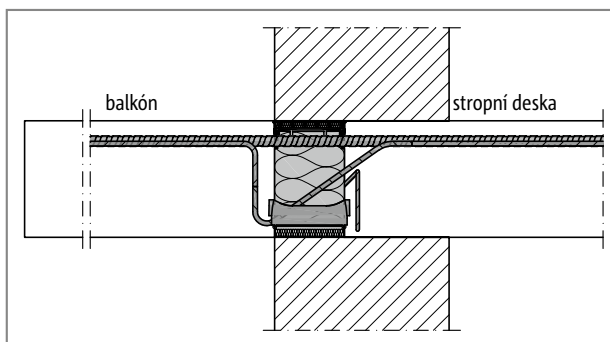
Schöck Isokorb® CXT typ KL: Balkón na zalomené fasádě
